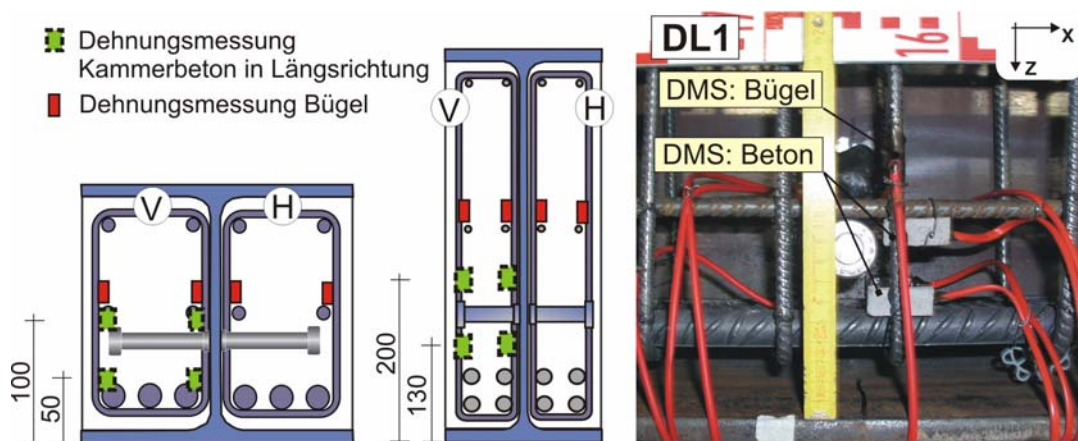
Messung der Betonstauchung des Kammerbetons bei negativer Momentenbeanspruchung
